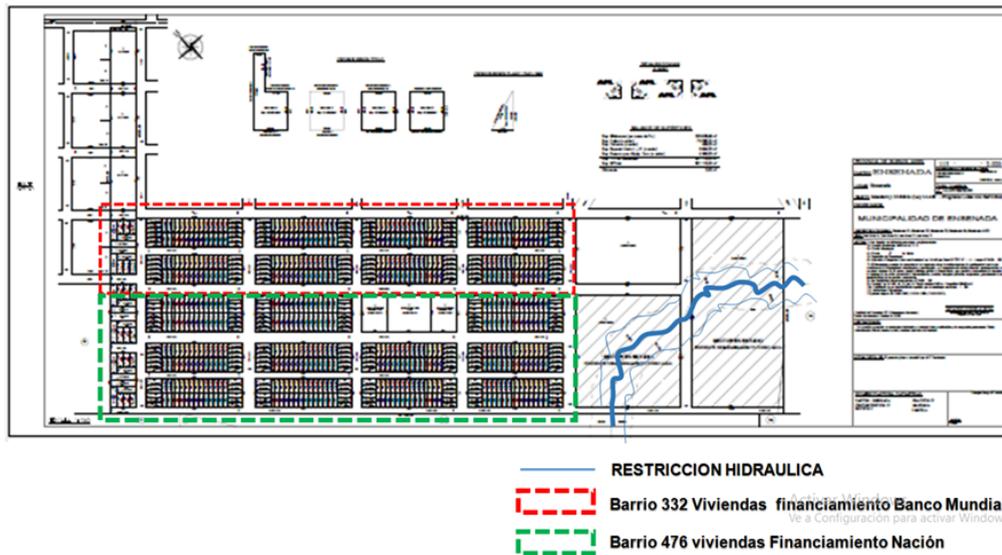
Proyecto de parcelamiento conjunto entre el proyecto 332 viviendas (BM) y 476 viviendas (Nación). Fuente: Elaboración propia IVBA
